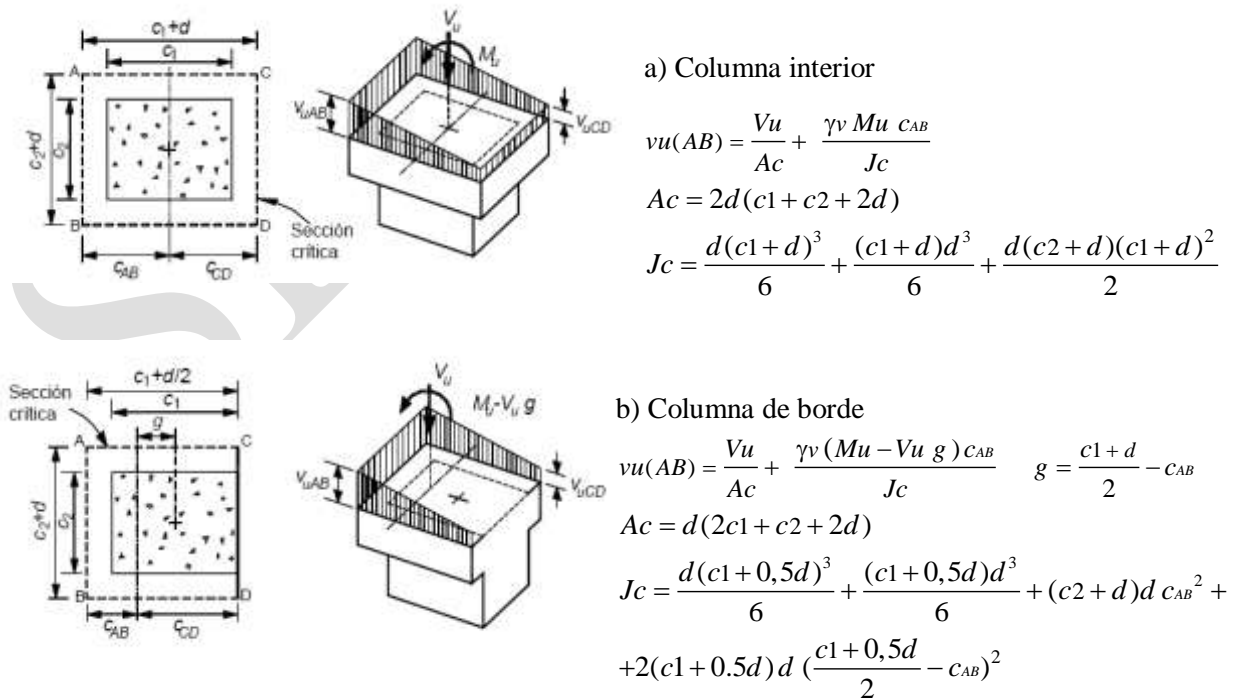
Distribución de los esfuerzos cortantes en el perímetro de la sección crítica en conexiones losa a columna.
